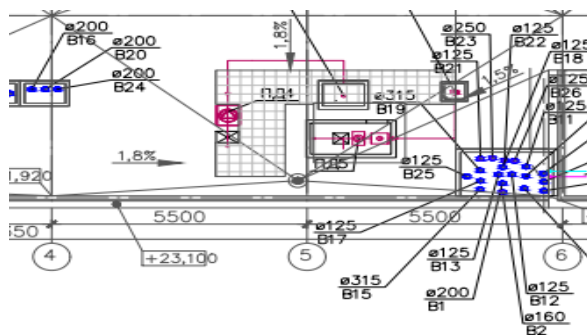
Системы ПД4, ПД5 на плане кровли
